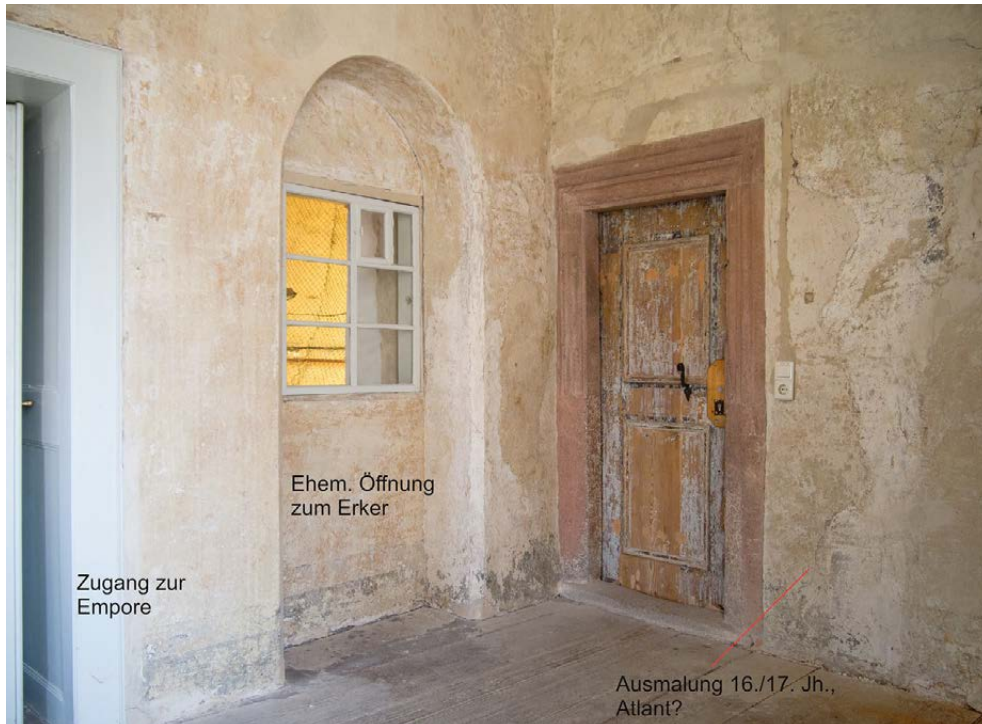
Waldheim, ehem. Schösserei, erstes Obergeschoss, Oratorium mit Öffnungen zu Erker und Empore, Ausbau um 1601
